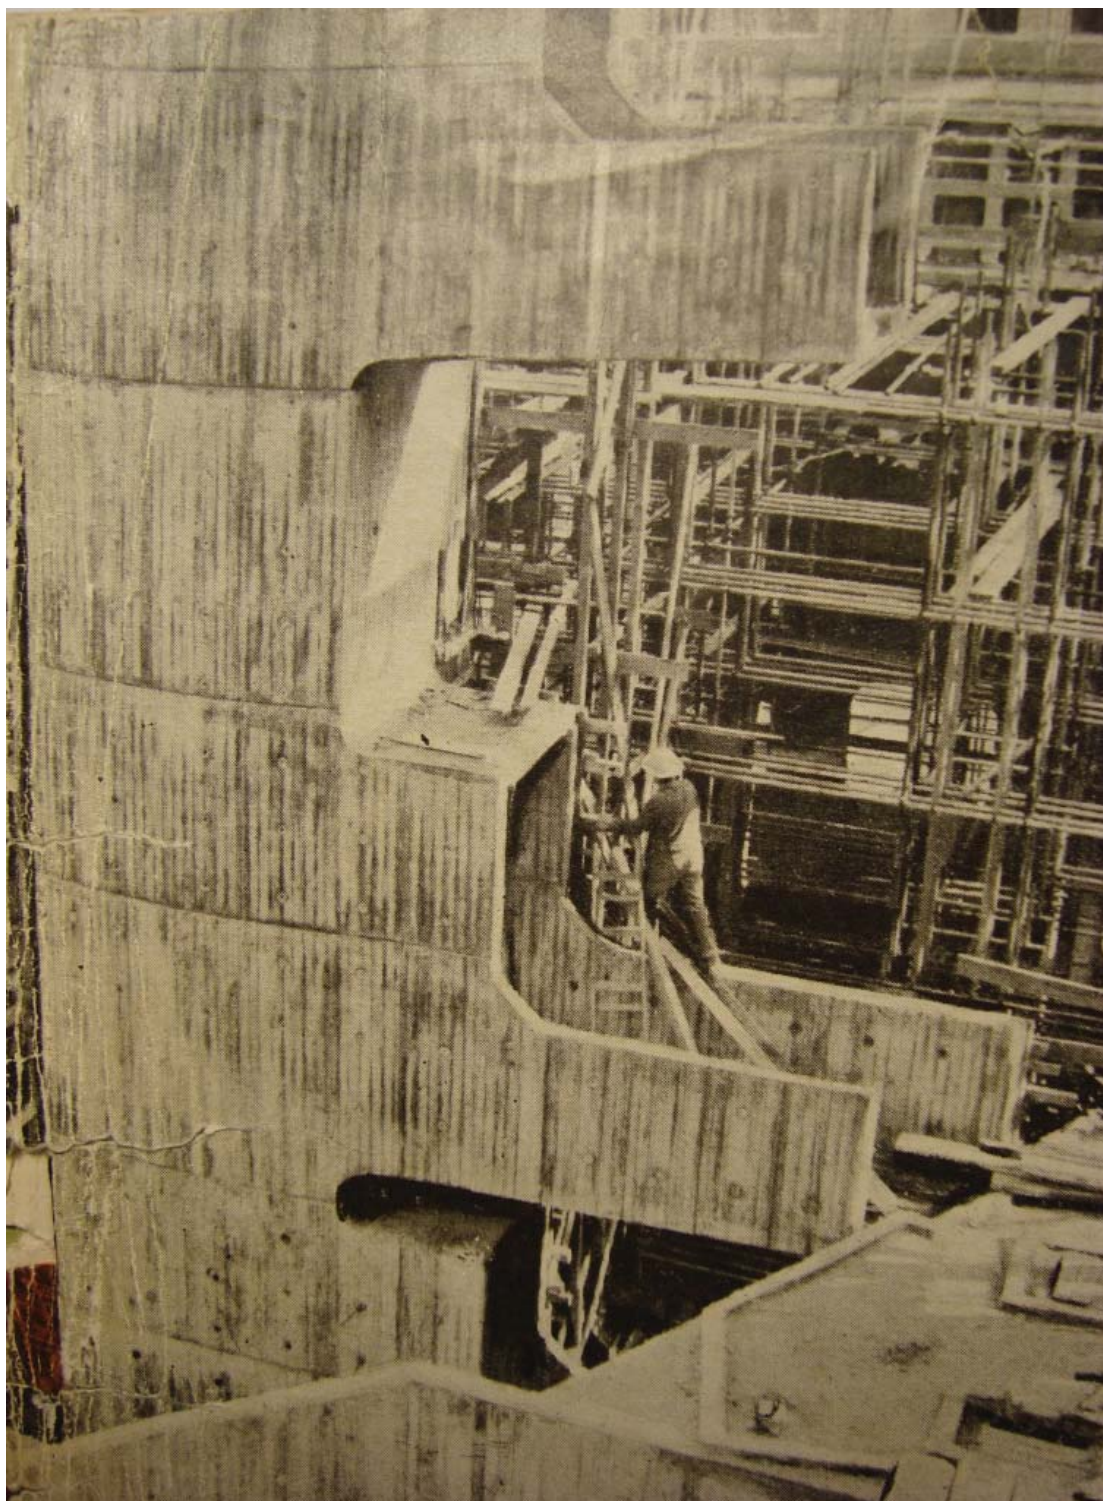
Banco de Londres, em construção. (Fonte: Construcciones. n.191, 1964.)
